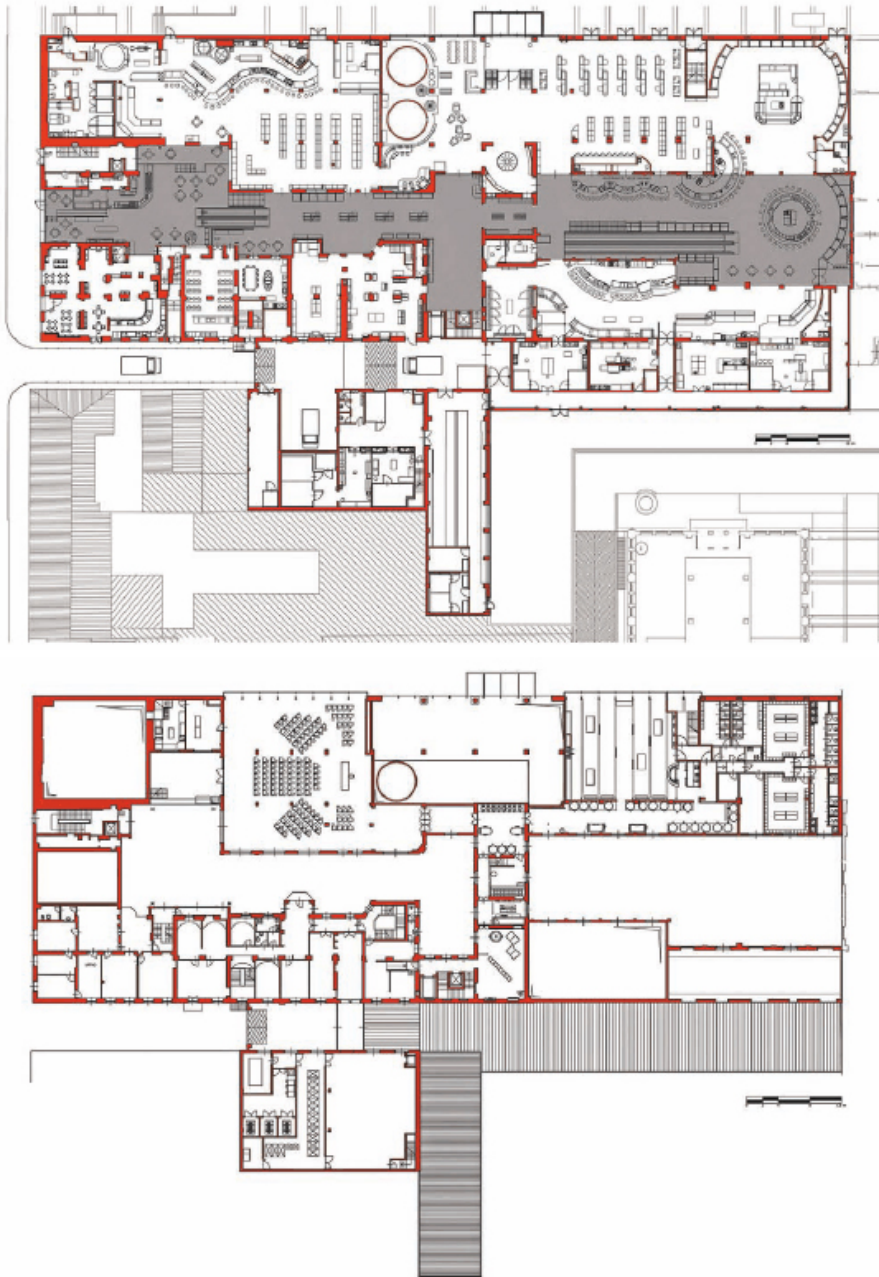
Planimetria del progetto di riuso dell'ex stabilimento Carpano (foto Filippo Gallino 2008).
